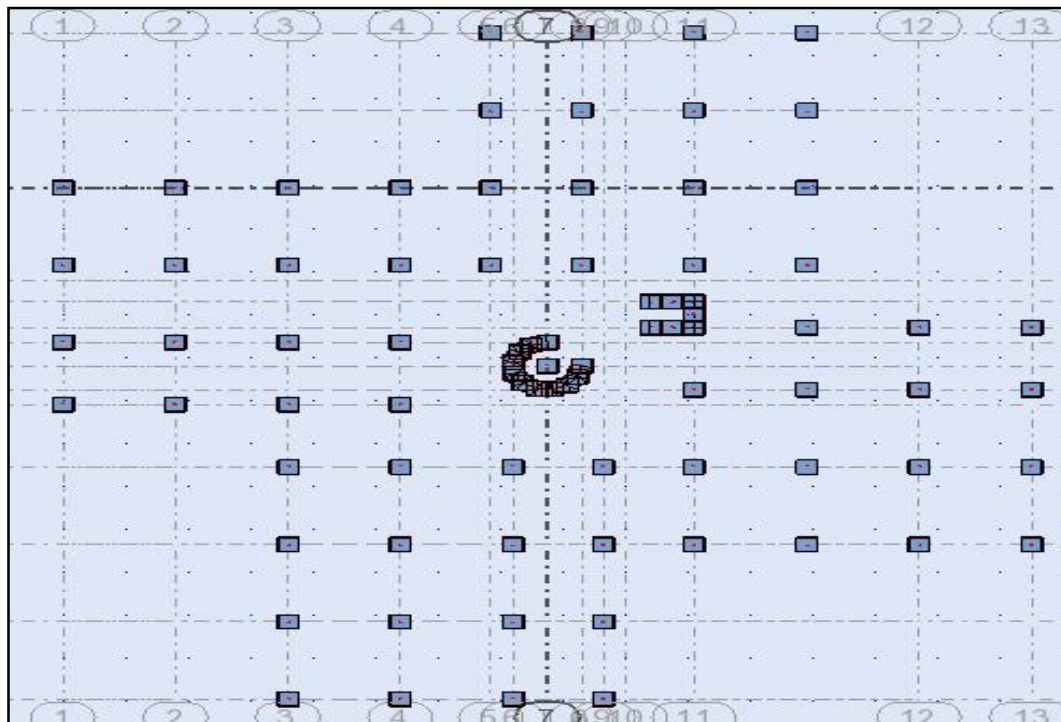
La 1ère disposition des murs voiles et poteaux
